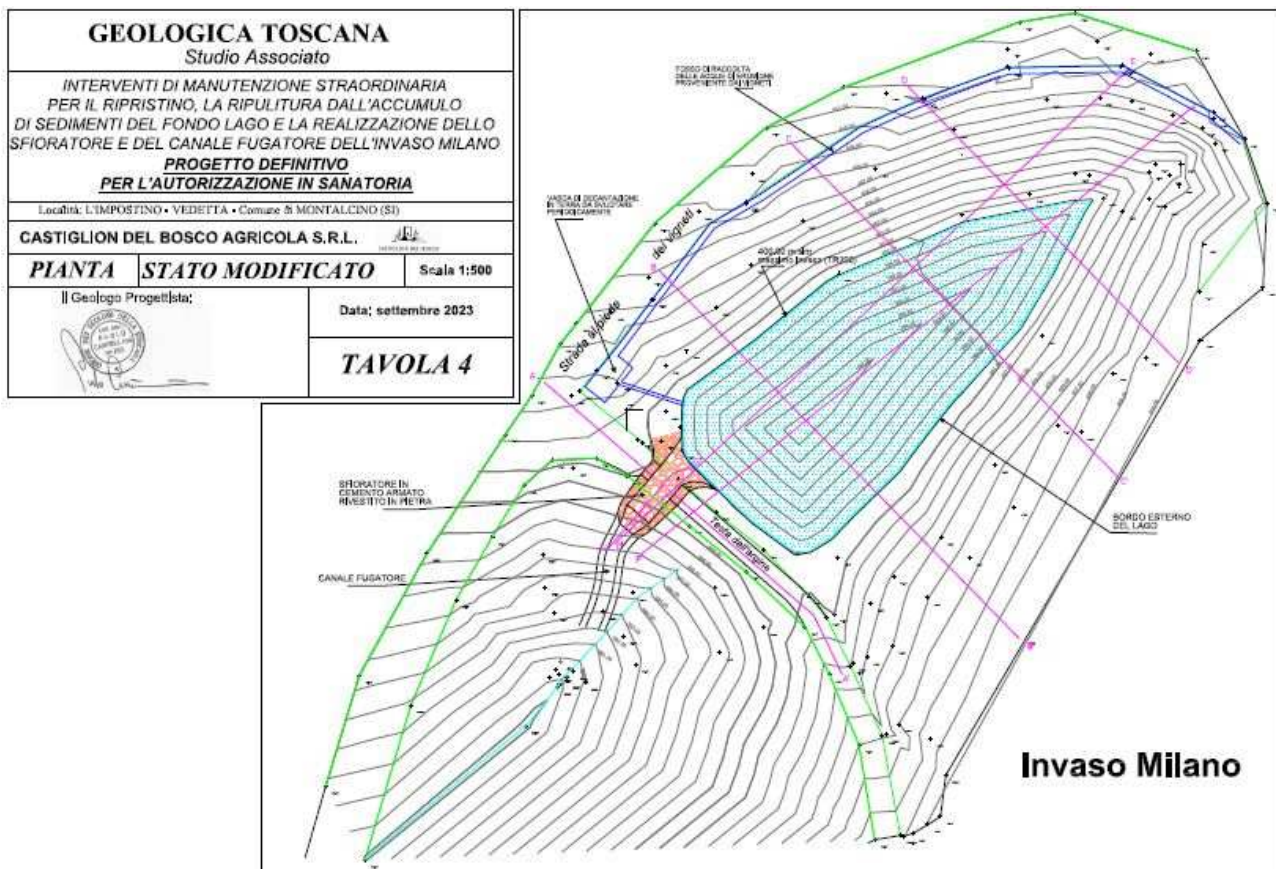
Estratto planimetria di progetto invaso “Milano”
